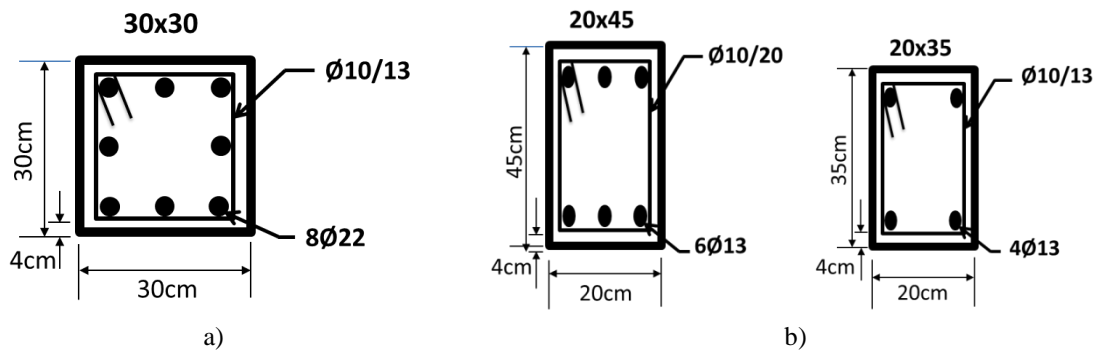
a) sección transversal de columnas y b) sección transversal típica de vigas Nivel 1
